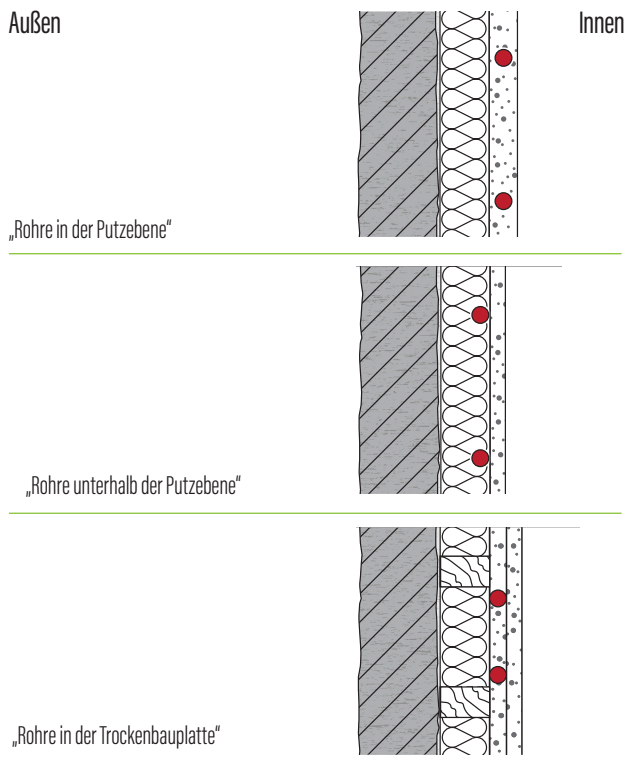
Grundlegende Ausführungsvarianten von wassergeführten Wandheizungssystemen
